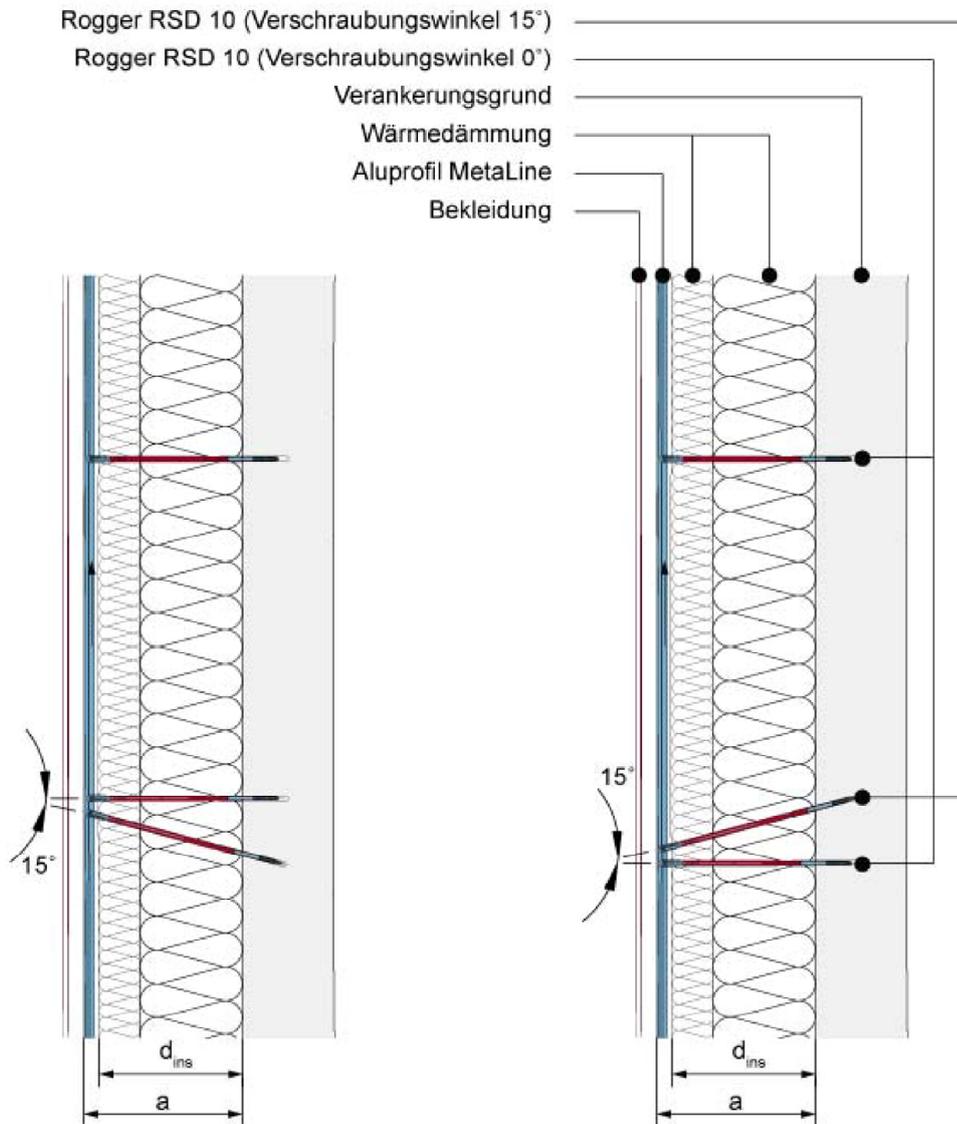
Fassade mit der Metallunterkonstruktion MetaLine (vorgehängte, hinterlüftete Fassade)
